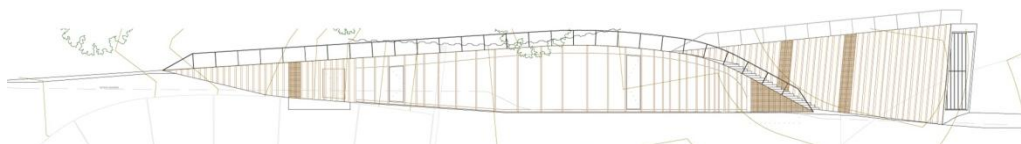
Alzado del edificio. Fuente: Ficha técnica Premios Construcción Sostenible.
